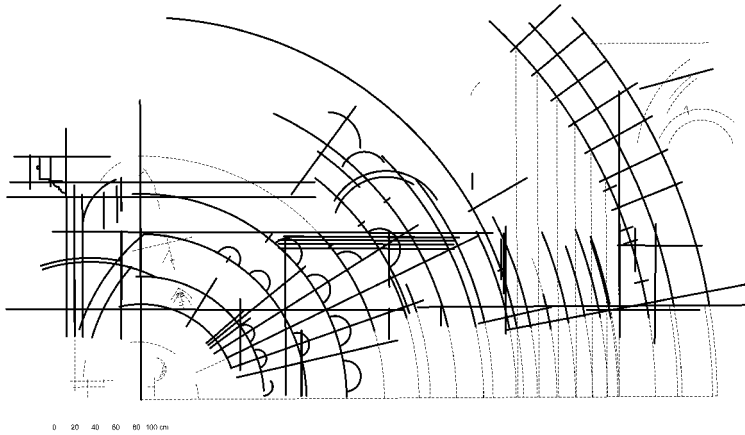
Trazado de cantería hallado tras la cajonería de la sacristía de la catedral de Murcia.
